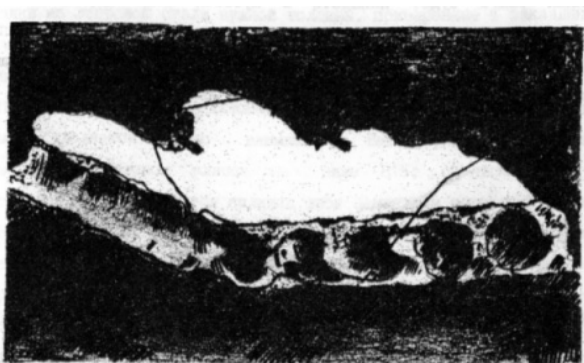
Отверстие, пробитое в пустотной плите перекрытия для пропуска коммуникаций. Из семи ребер перебито пять
